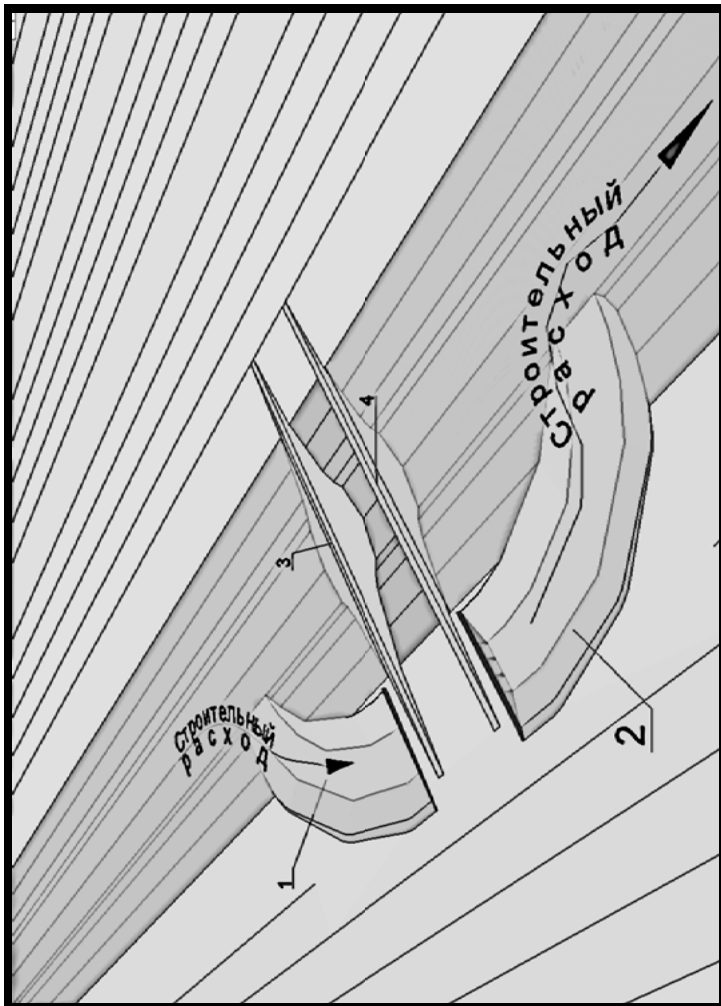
Схема пропуска строительных расходов второй очереди строительства «Береговая компоновка»:
